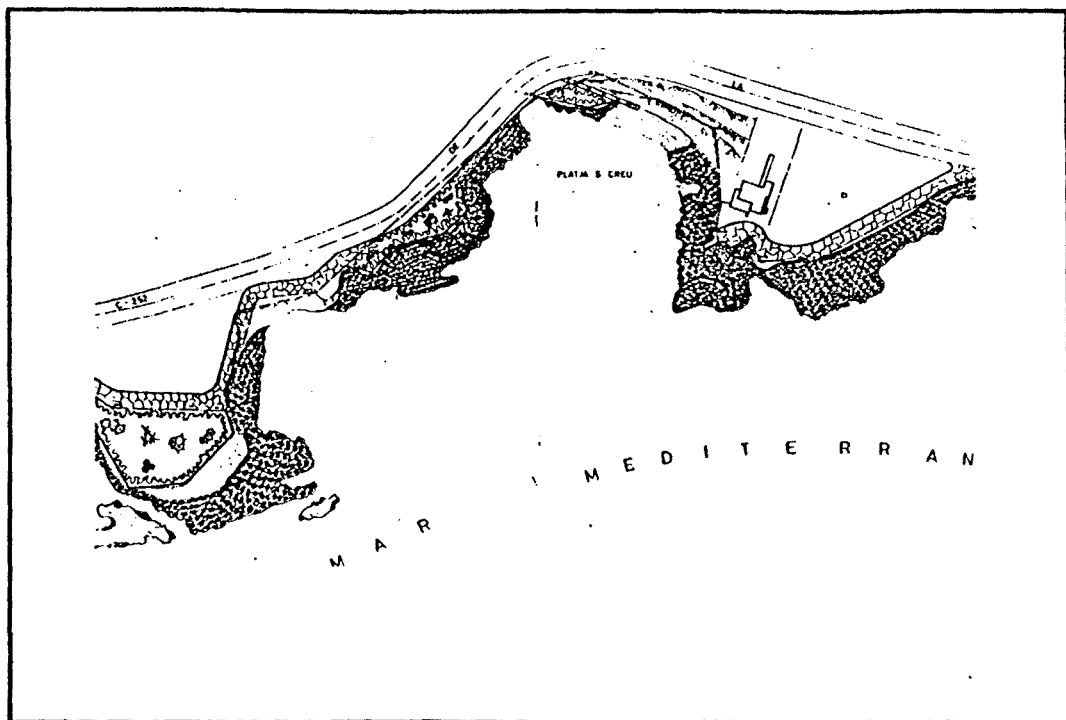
Pla General de 1.984. Llançà. Sector Platja Santa Creu.
